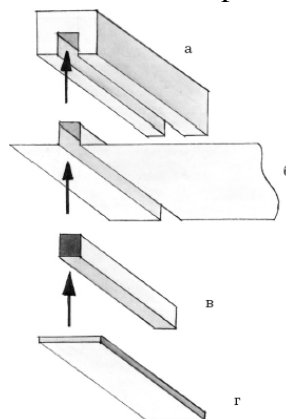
Устройство потолка кулачкового крепления: а – крепежный профиль; б – полотно; в – фиксирующий клин; г – багет
